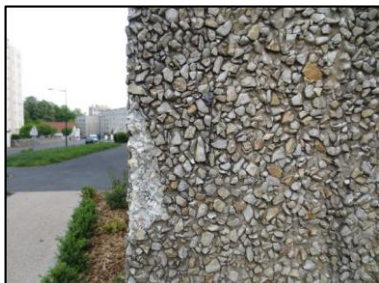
ECH-N°22 -BAT 177-277 pignons Murs béton+pierres
